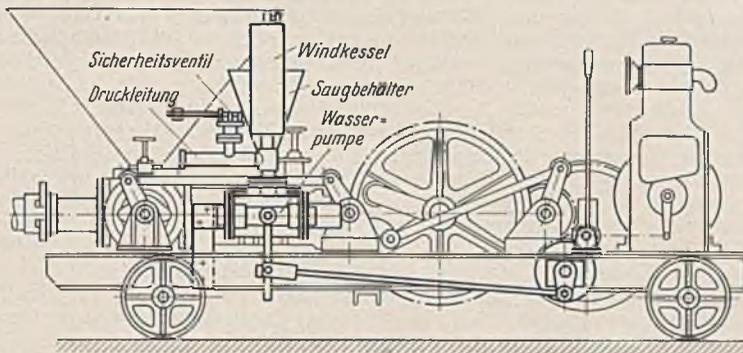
Betonpumpe mit angebauter Wasserpumpe zum Reinigen der Betonrohrleitung.
